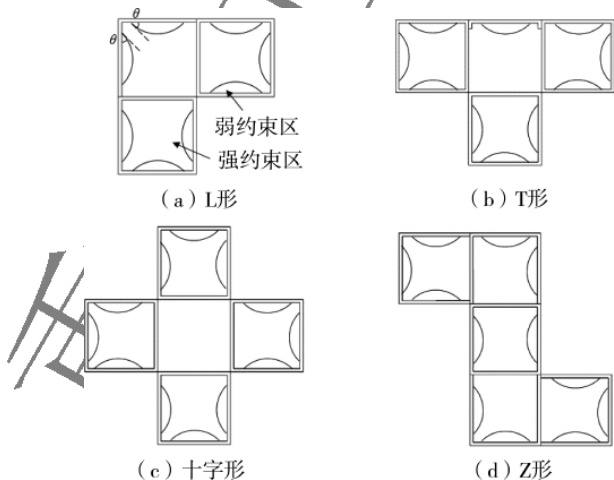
钢管混凝土异形柱混凝土强弱约束区划分
